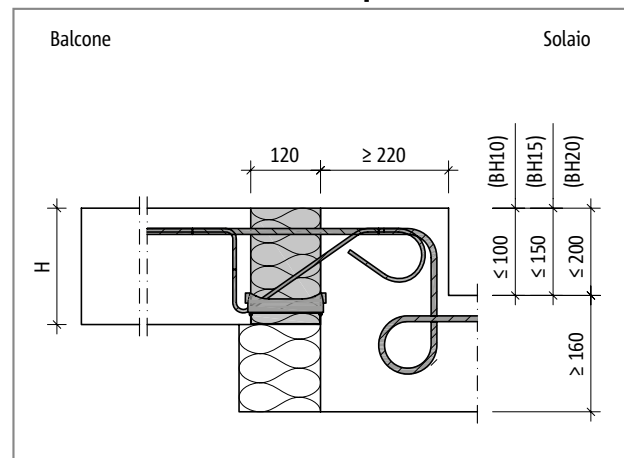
Schöck Isokorb® tipo KXT-BH: balcone con innalzamento e isolamento esterno
